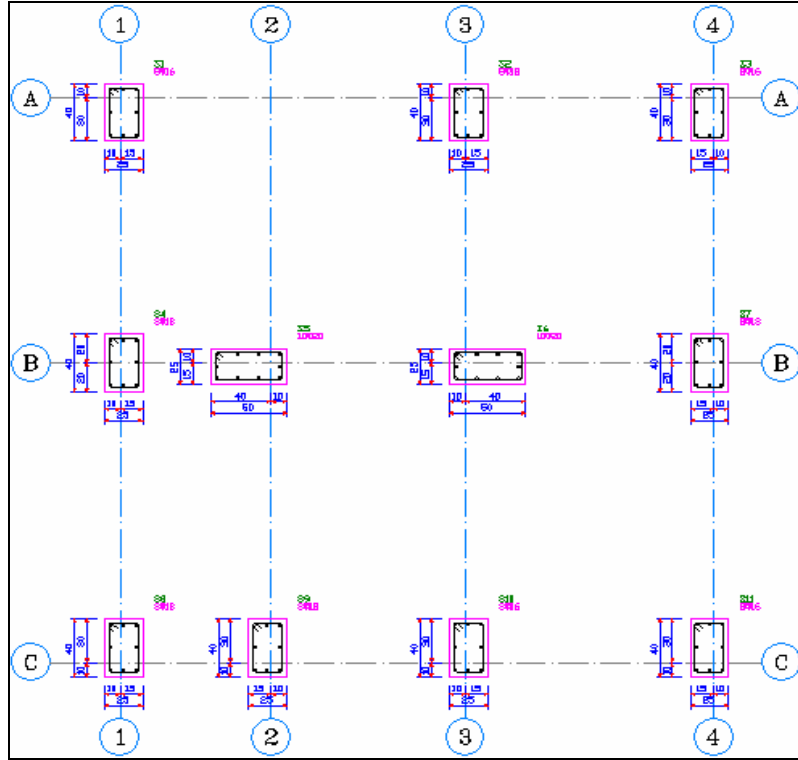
Kirişli döşemeye sahip 2 katlı betonarme çerçevesi yapının kolon aplikasyonu
